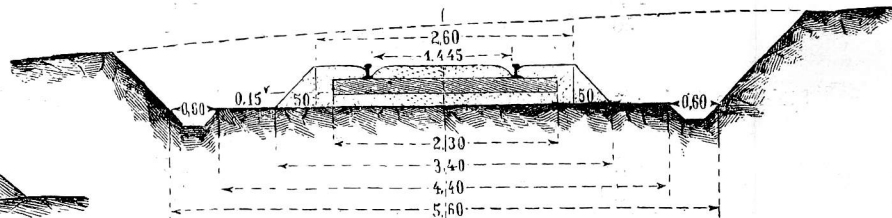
Billige Regelspur I mit Fahrzeugen der Hauptbahnen. Einschnitt mit freier Bettung.
